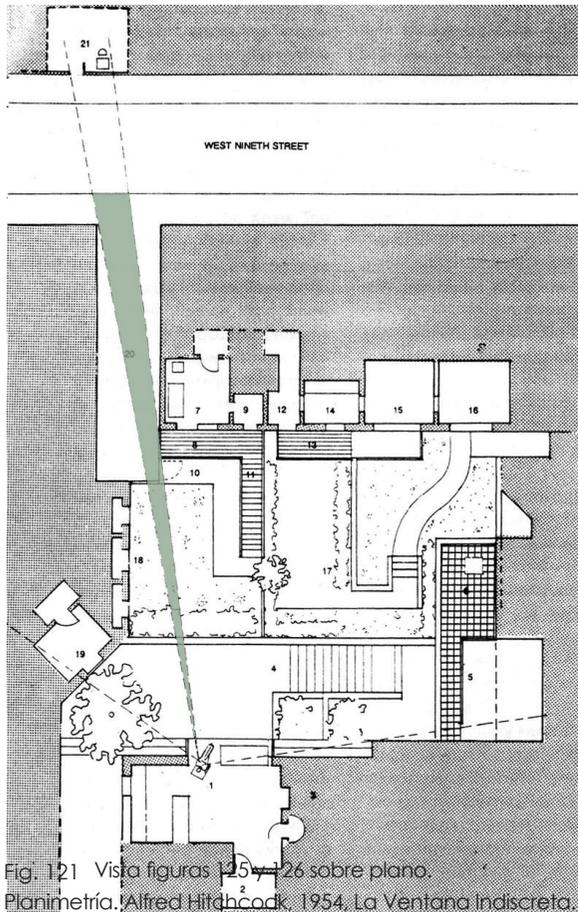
Vista figuras 125 y 126 sobre plano. Planimetría, Alfred Hitchcock, 1954, La Ventana Indiscreta.
